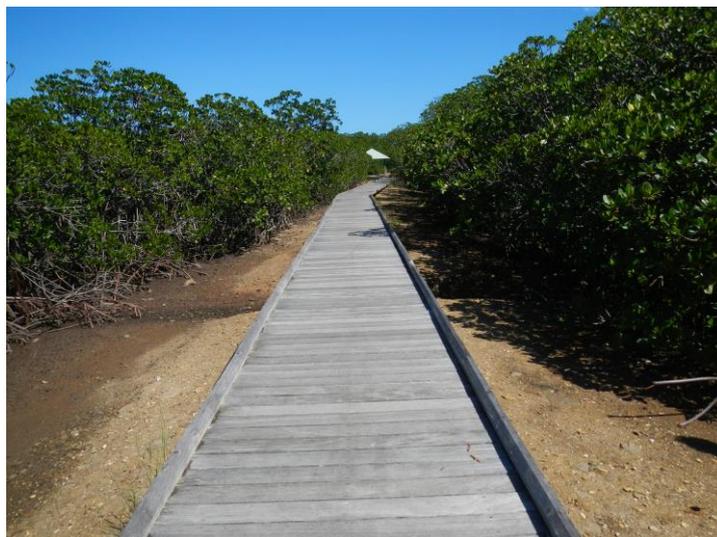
Photo du platelage existant sur le parcours existant de la mangrove
